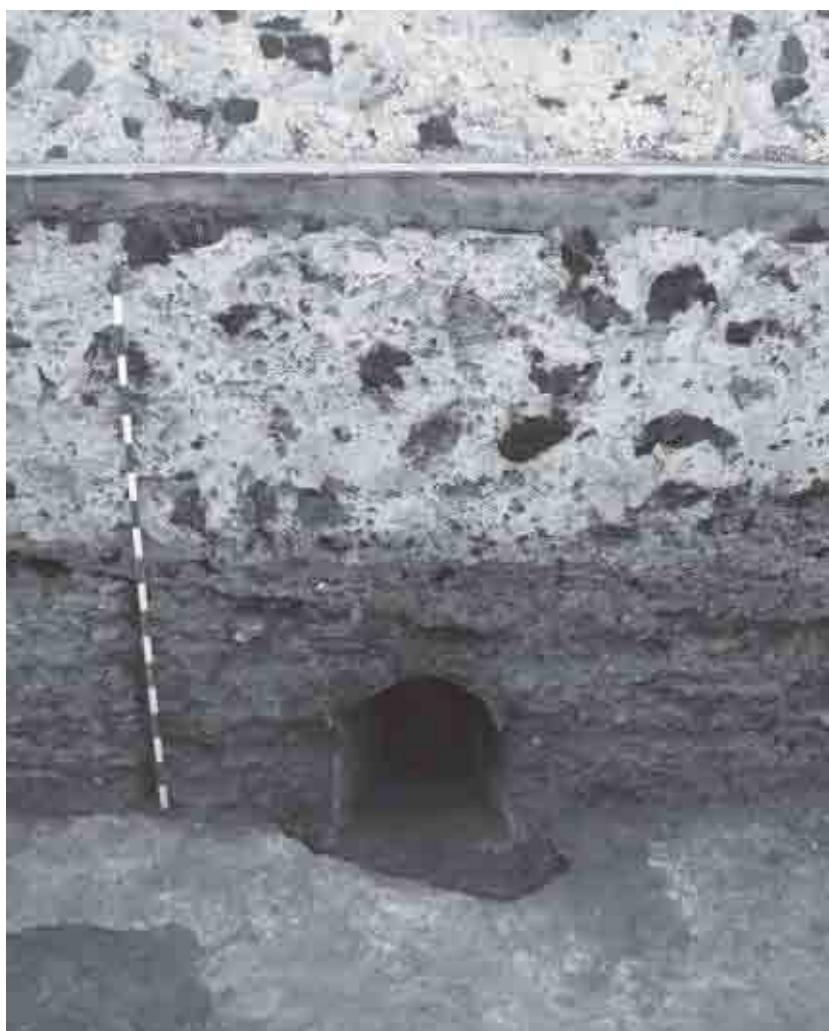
Aspíllera abierta en el extremo norte de la muralla sureste del recinto meridional
